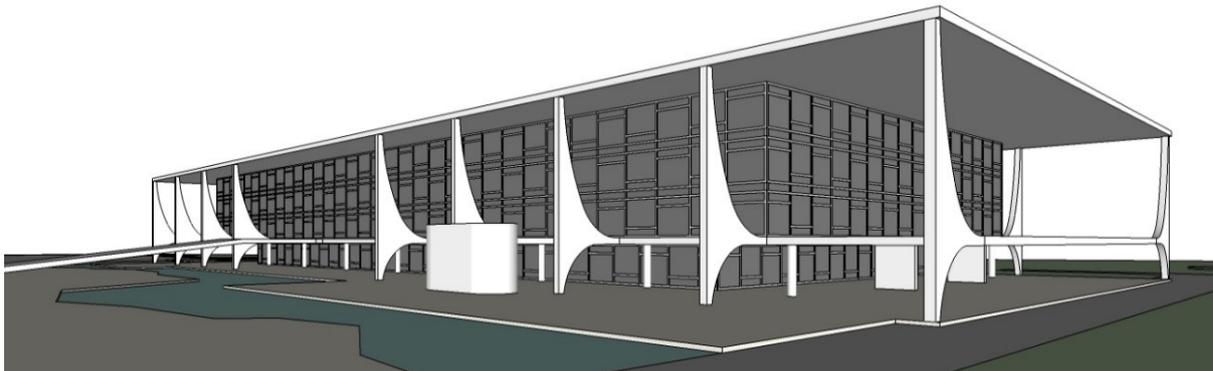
Perspectiva conceitual do Palácio do Planalto, vista sudeste, fachada principal.
